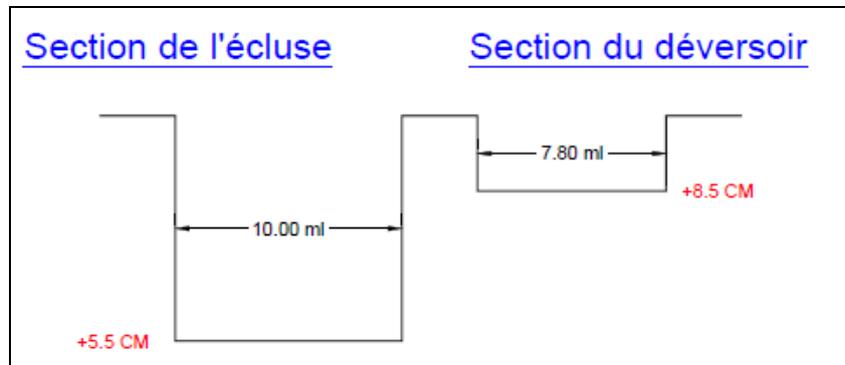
Schéma porte – seuil du bassin à flot - Extrait plan masse DCE dévasage et hydroagitation CETIA 2020
